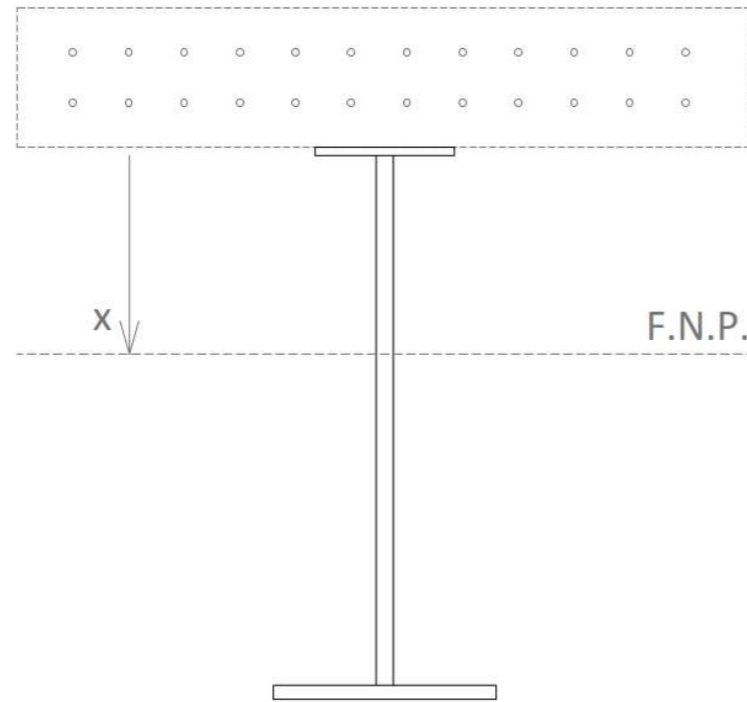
Fibra neutra plástica en el alma de la viga transversal, en flexión negativa de eje horizontal (fuente: elaboración propia)
